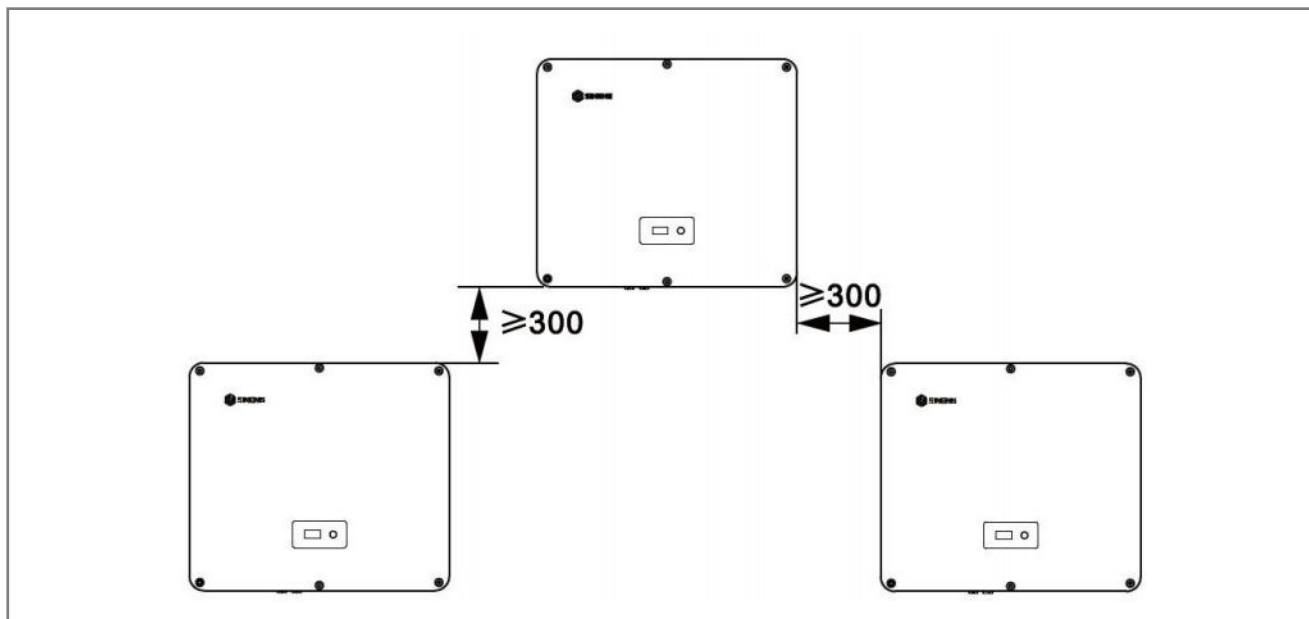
Schema della modalità di installazione sfalsata su più file (unità: mm)
